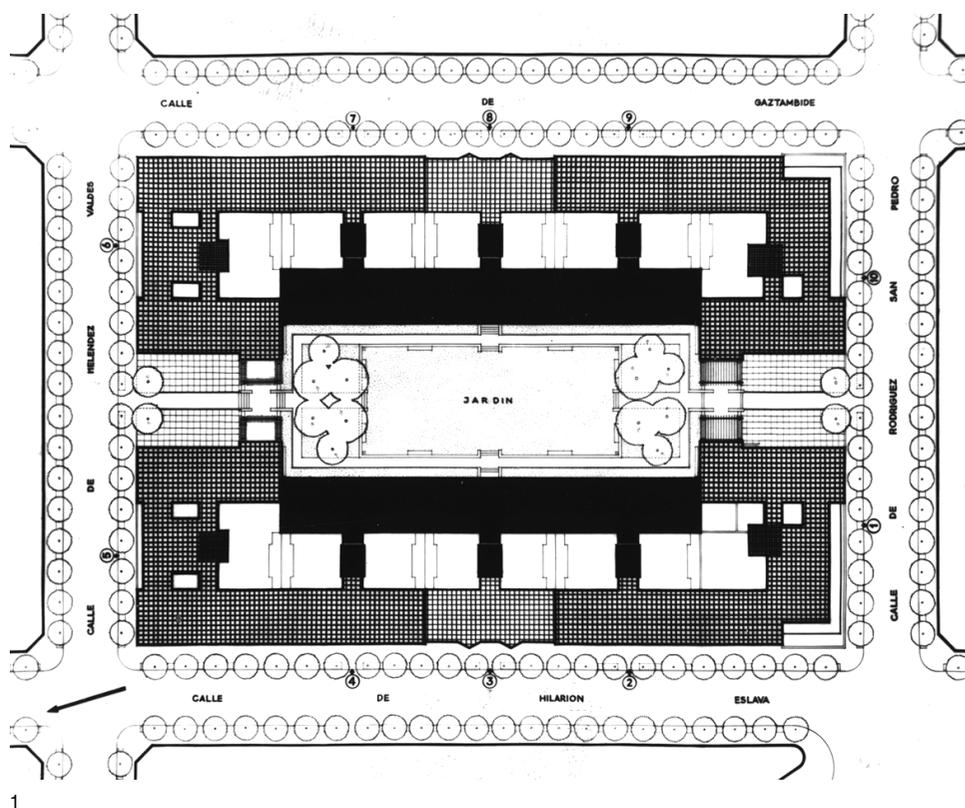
Planta General de la Casa de las Flores, Madrid, 1931
